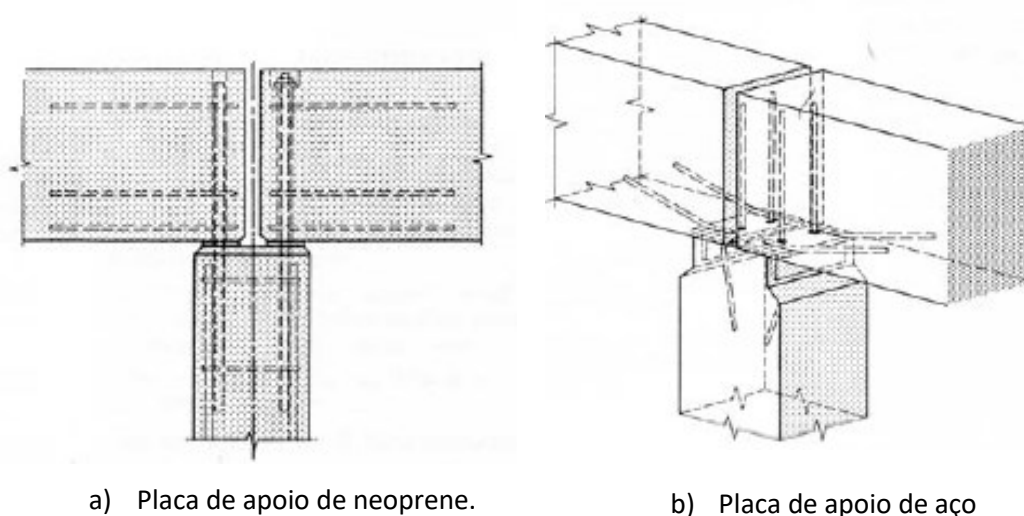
Ligação pilar – viga através de placas de apoio de neoprene ou aço (STUPRÉ, 1981).
